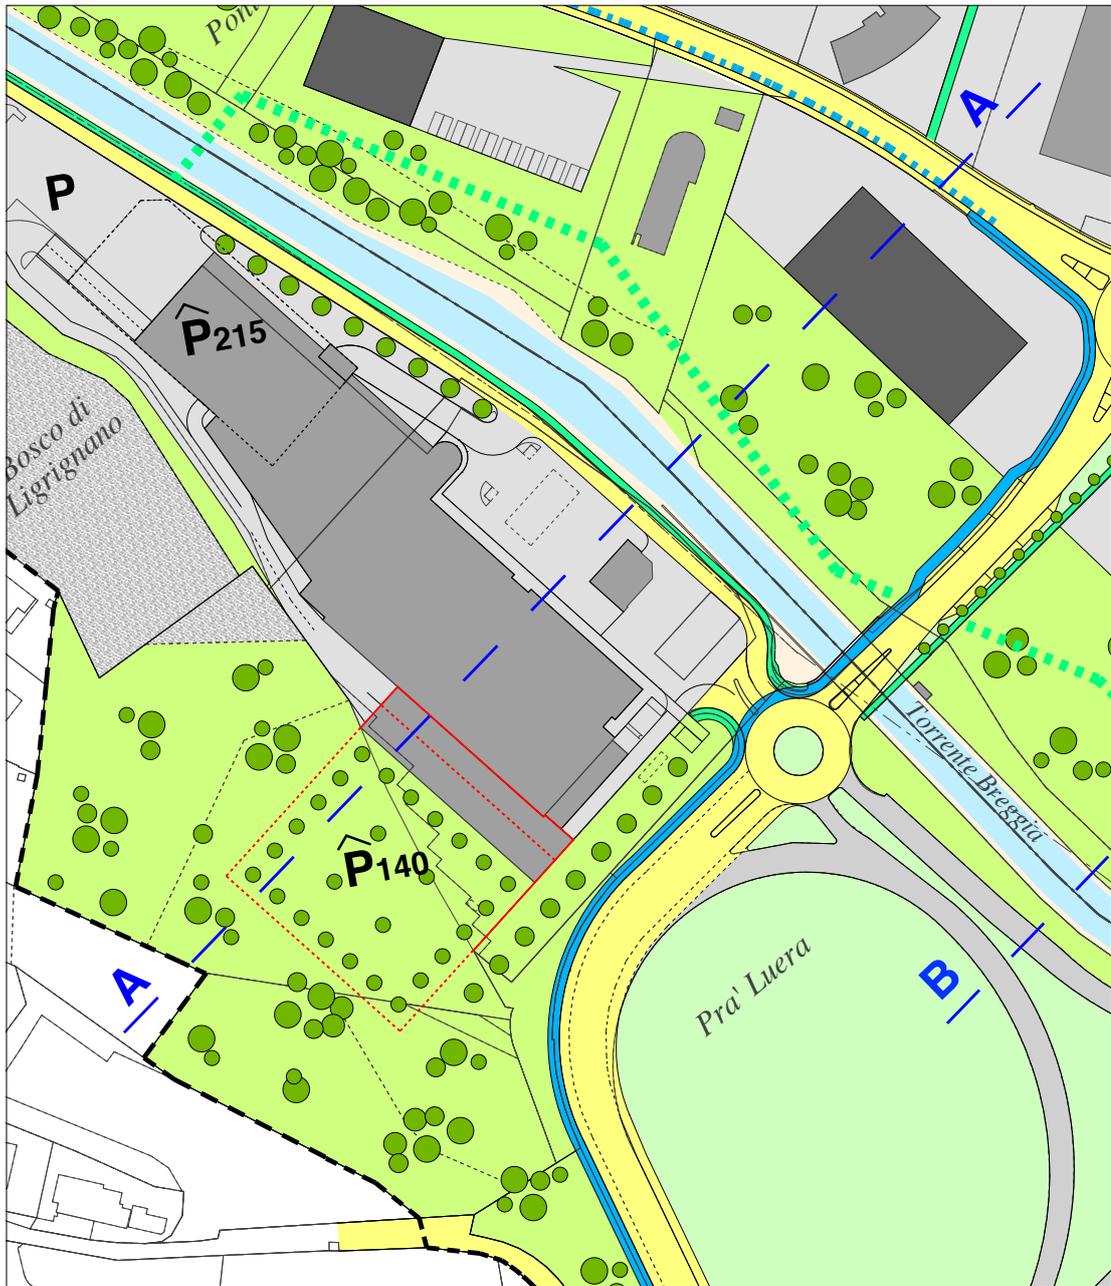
planimetria e sezione prima soluzione ampliamento Centro Breggia
